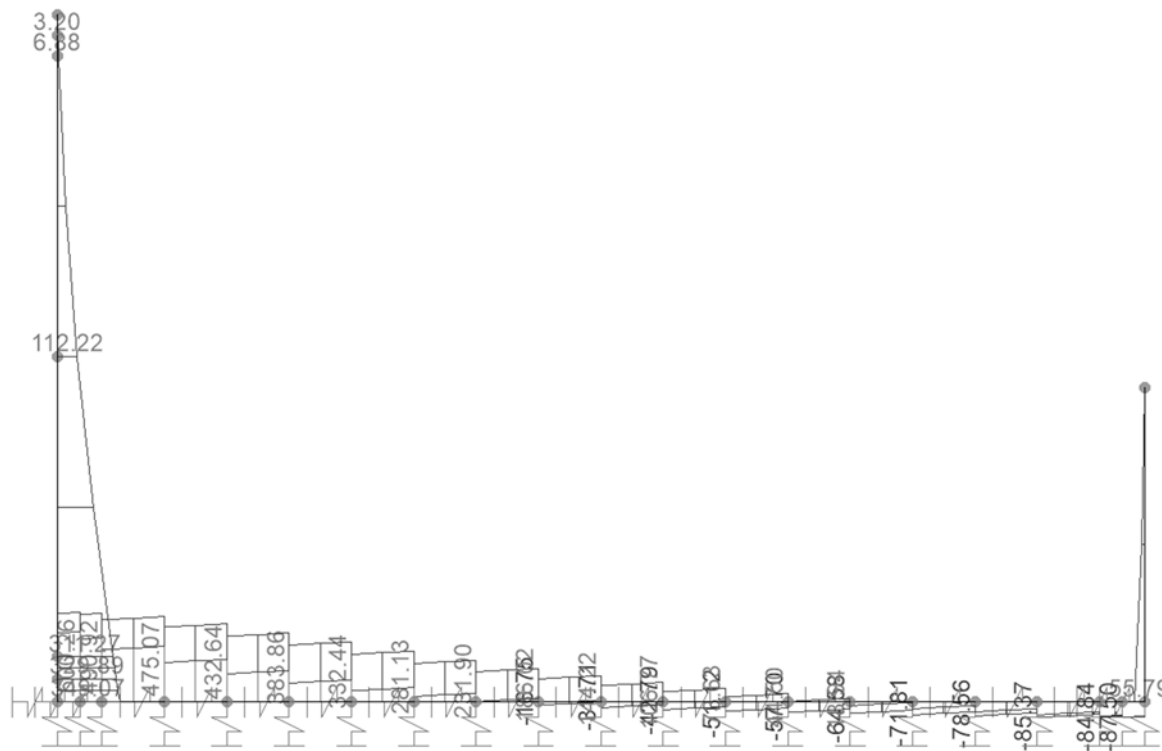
SLE.rara – Piedritto e platea di fondazione – Tagli Ved
